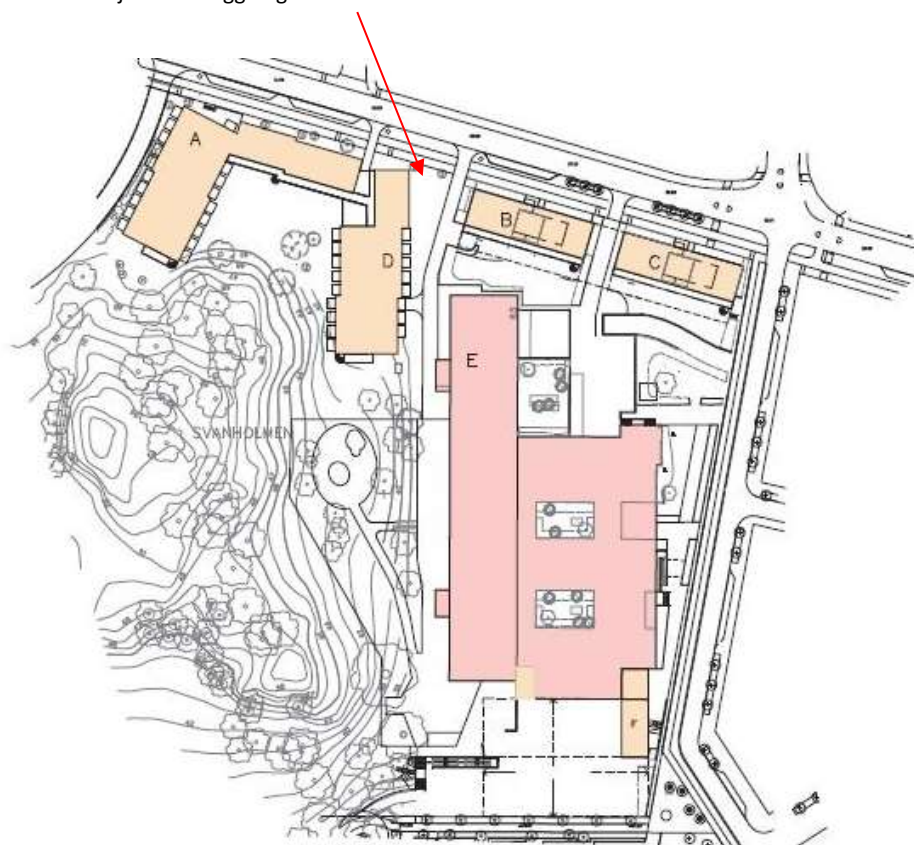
Förenklad Situationsplan för Svanholmen 1, framtagen av Wåhlin arkitekter i samarbete med Bolite. Nya byggnader är A, D, B, C och F. Bostadshusen A-D föreslås placeras utmed Värbergsvägen. Befintlig f.d. sjukhusanläggning hus E. Mot baksidan av sjukhusanläggningen föreslås ett garage. Bilden är beskuren.
